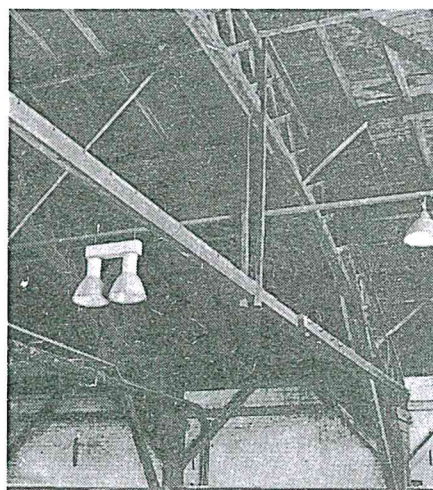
Lagerhalle, Konstruktionsprinzip Stephan
